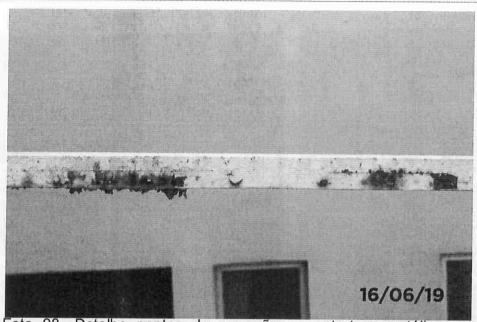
Detalhe pontos de corrosão na estrutura metálica no guarda corpo.
